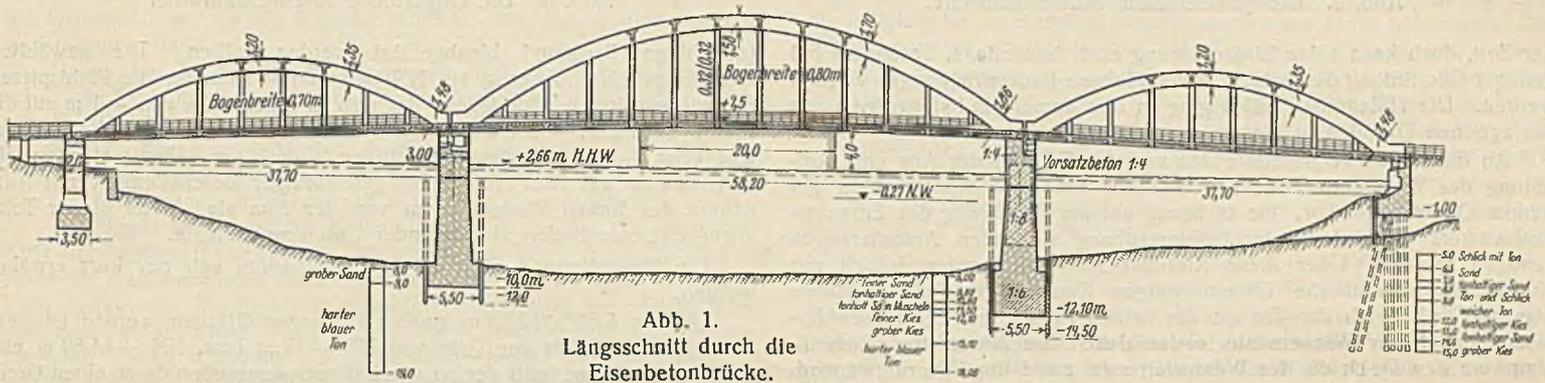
Längsschnitt durch die Eisenbetonbrücke.
